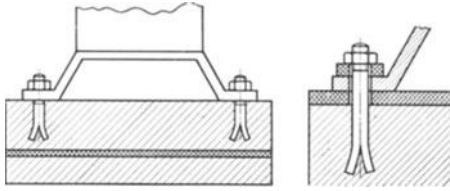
Körperschalldämmende Befestigung mit Platten oder Gummifedern.
